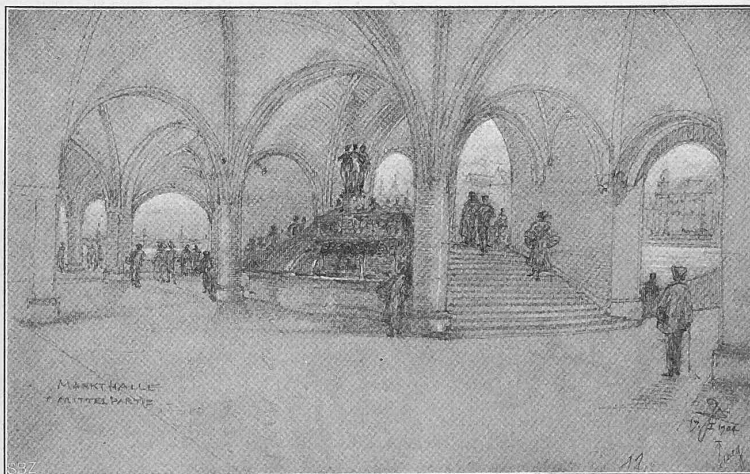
Entwurfsskizze der Mittepartie der untern Markthalle mit dem Treppenaufgang zur Terrasse vor dem Gebäude des grossen Stadtrats.
